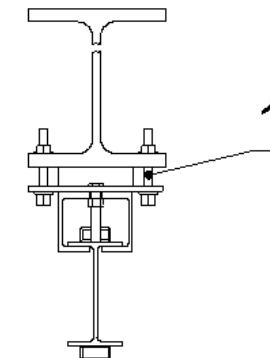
Крепление с помощью универсального кронштейна со сверлением отверстий в несущей конструкции
